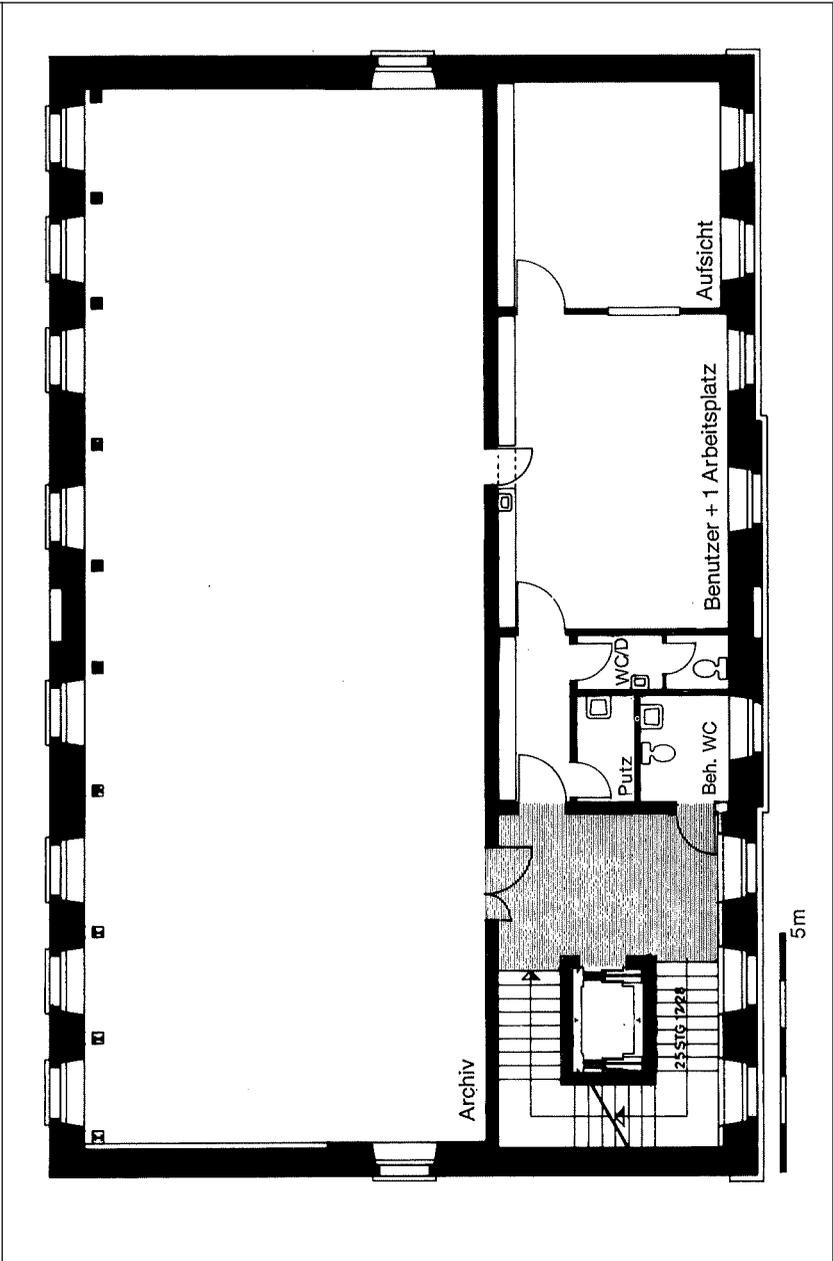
Stadtarchiv Wuppertal, Archivgebäude. Obergeschoß-Grundriß.
